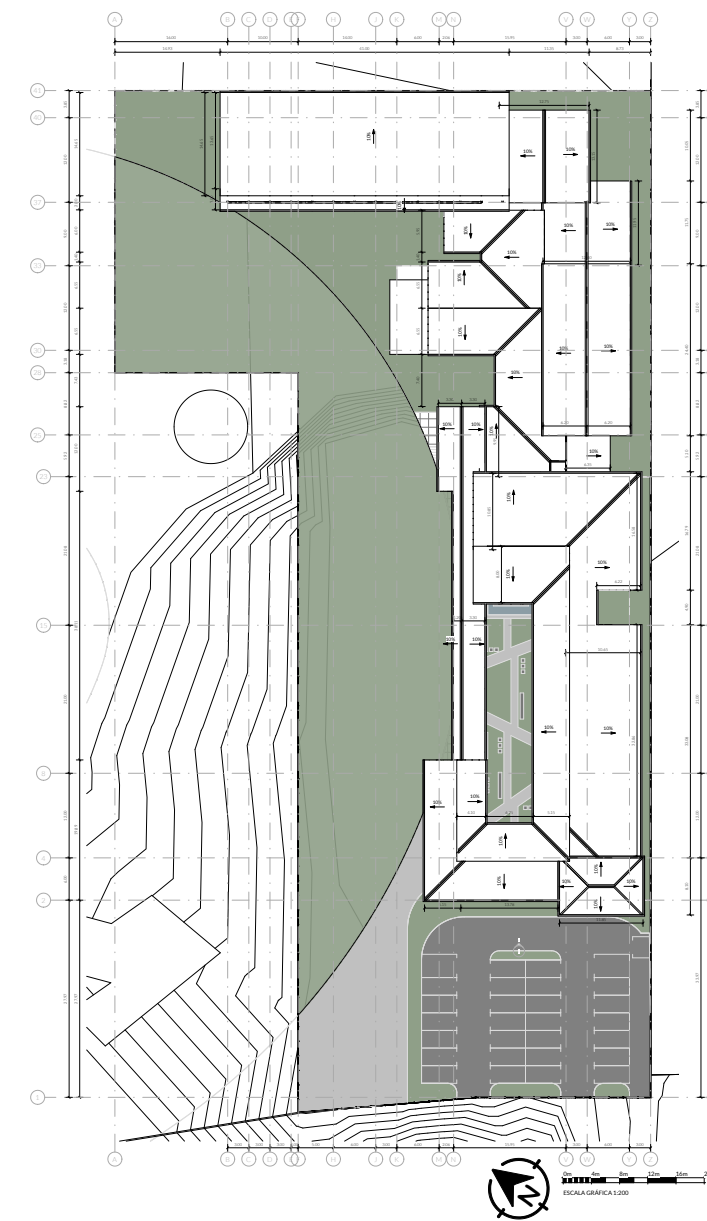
Planta de cubiertas del IAP. Elaboración propia.
